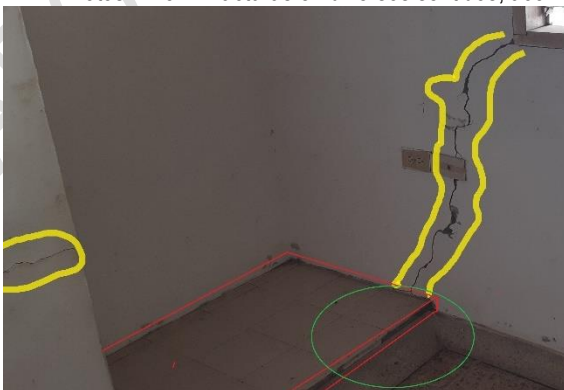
Completo deterioro de las losas, y muros, con patologías de descalcificación, grietas y humedad.
